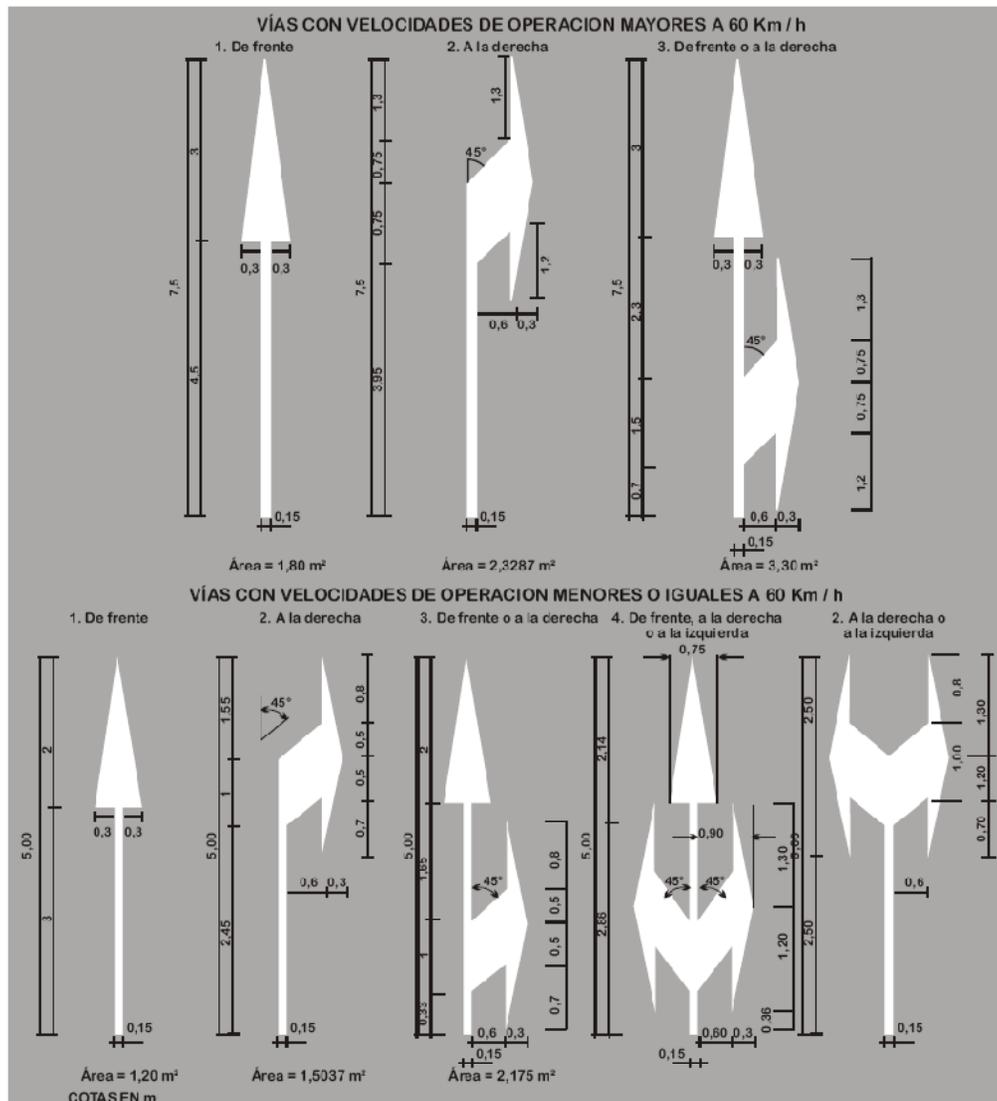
Flechas en el Pavimento (medidas en metros).
